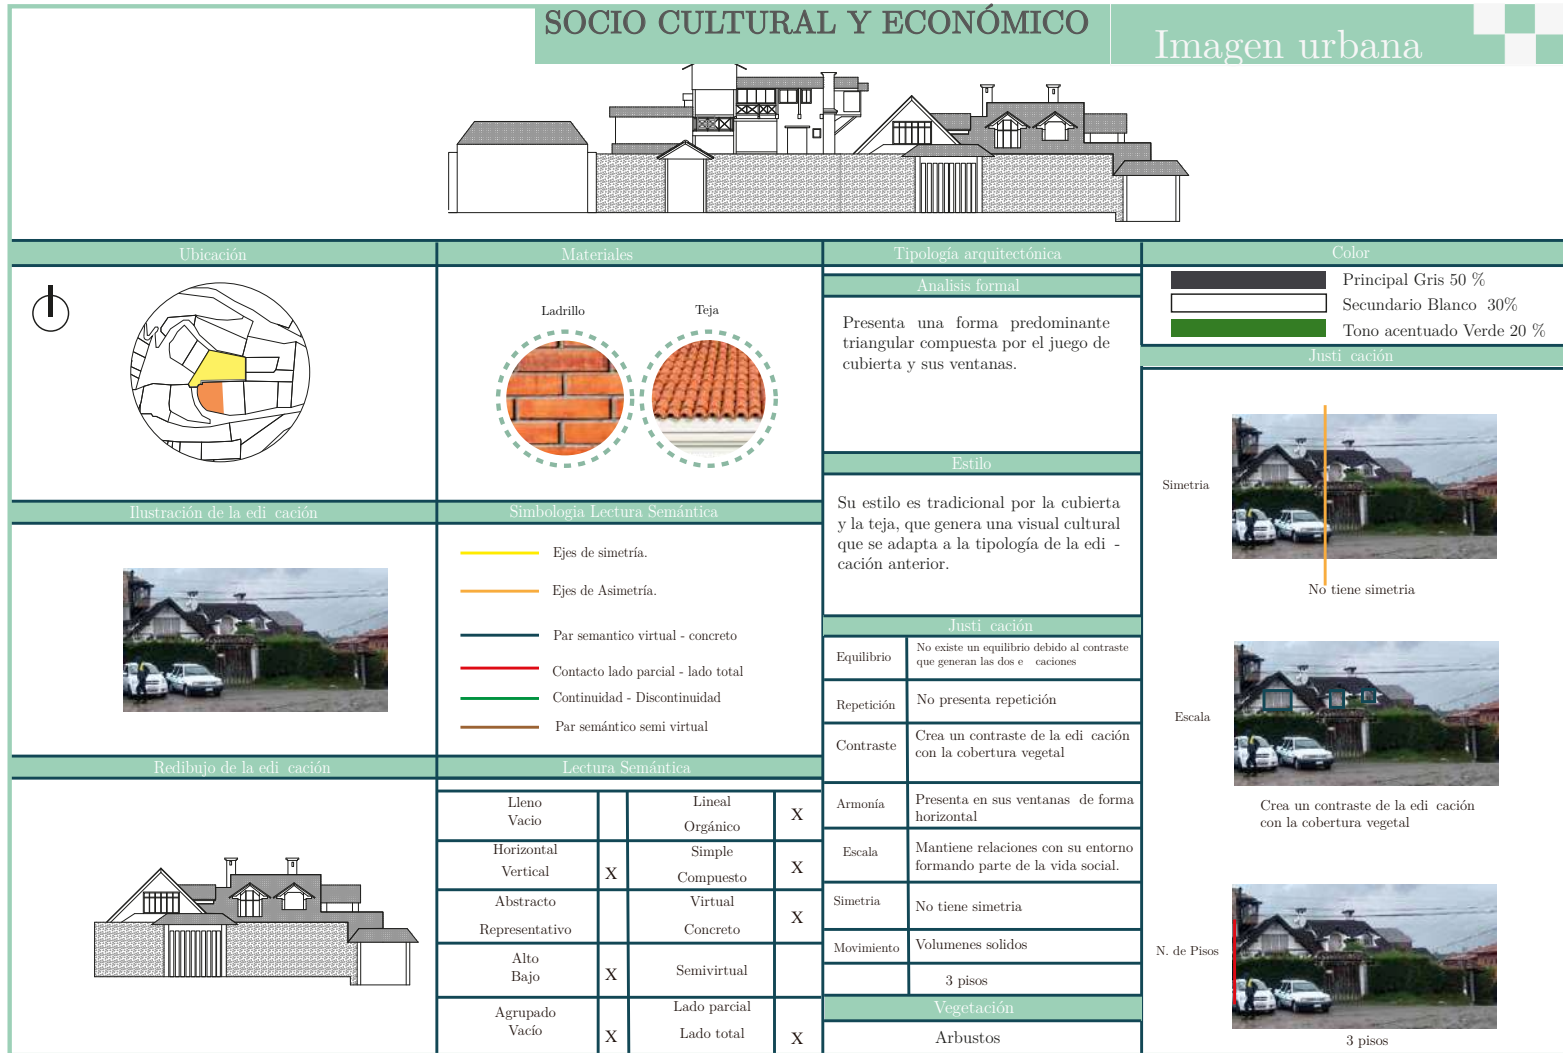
Levantamiento de la imagen urbana sur por edificación. Fuente y elaboración: Propia.
